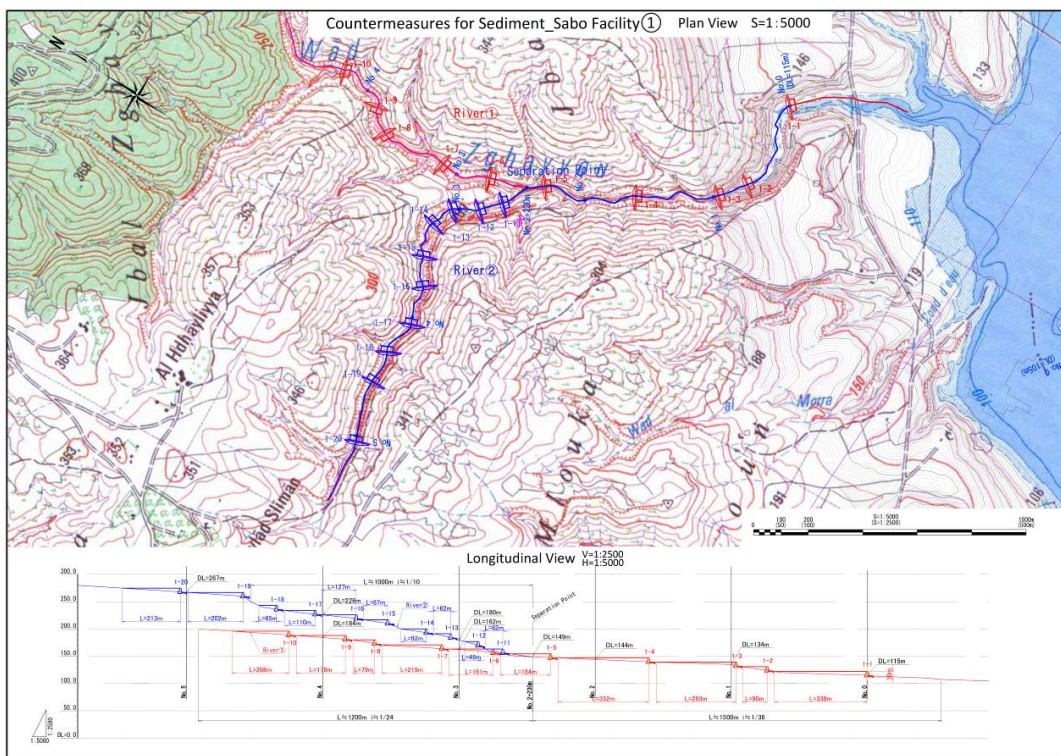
Plan d'aménagement des installations de barrages de contrôle (1) Wad Zghayyou
